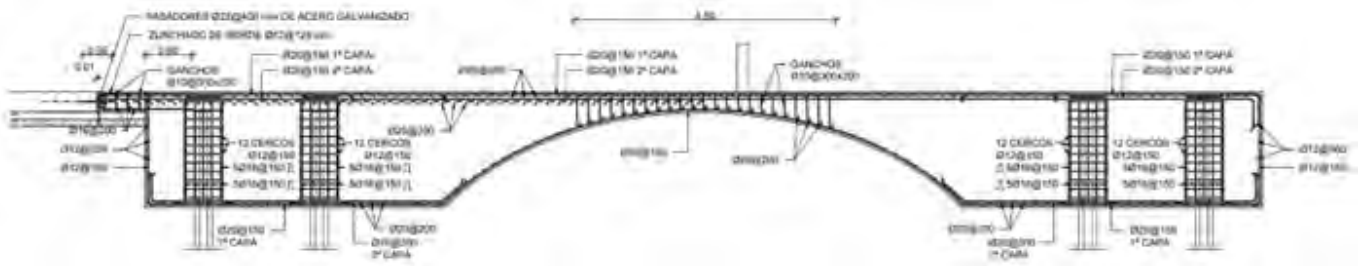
Detalle de armado de la losa inferior sobre la bóveda del túnel.
